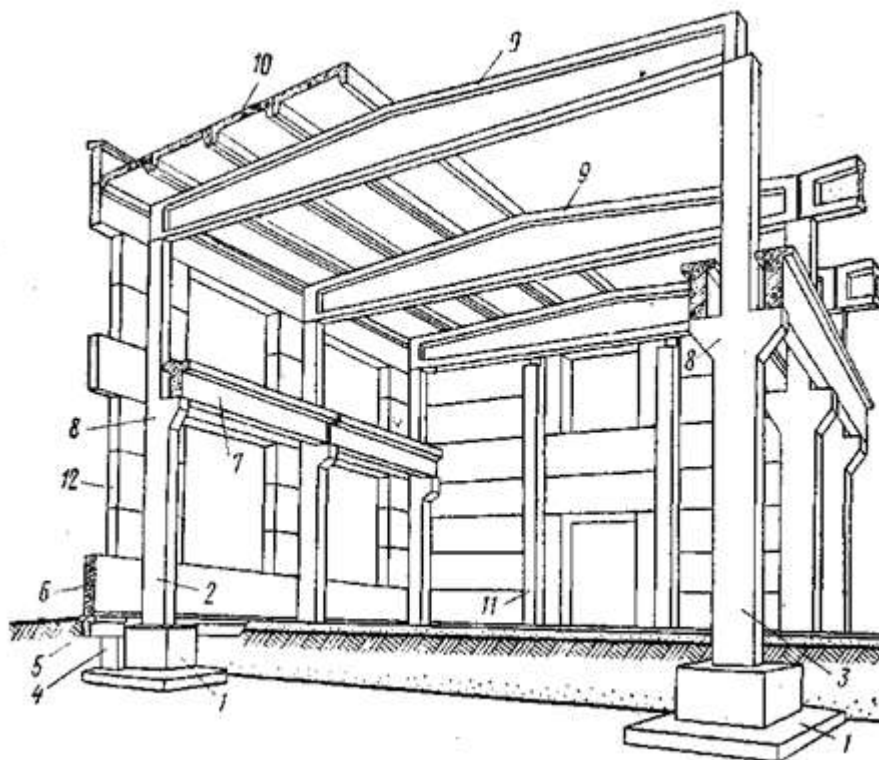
1. Ступень фундамента, 2. Колонна, 3. Средняя колонна, 4. Столбик под ФБ, 5. Фундаментная балка, 6. Стеновая панель, 7. Подкрановая балка, 8. Консоль колонны, 9. ЖБ Балка 12м, 10. Плиты покрытия (ПП). 11. Колонна торцевого фахверка.
